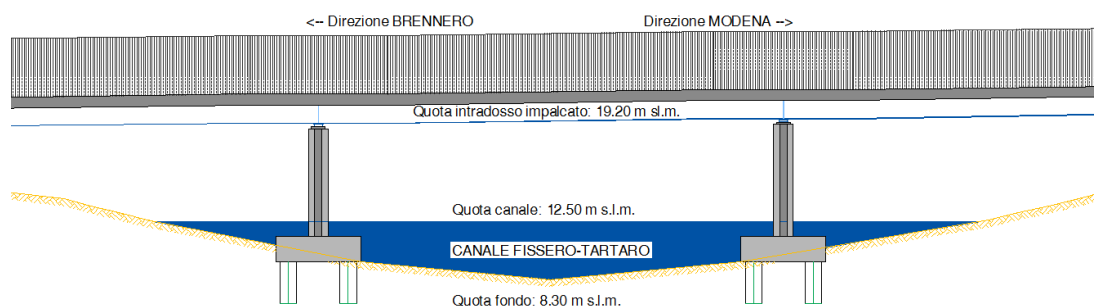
Sezione trasversale del nuovo ponte autostradale
